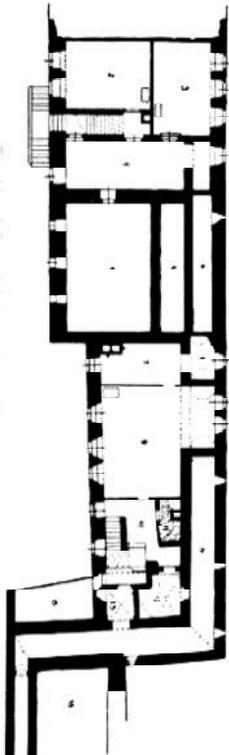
Löbau, Franziskanerkloster: Grundriss mit freigehaltenem Wehrgang
